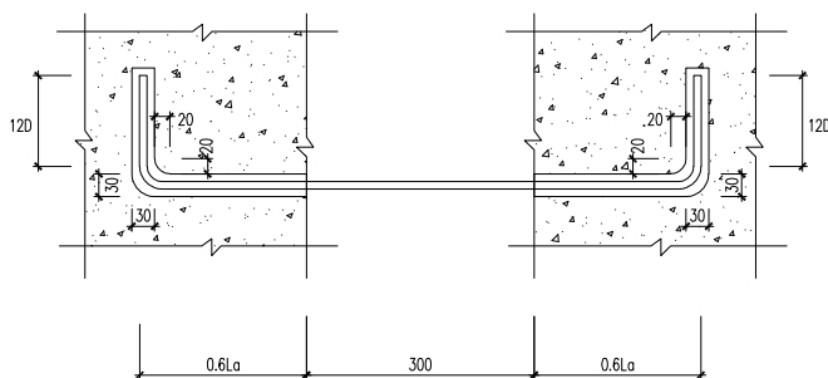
不出筋叠合板后浇区中部]型连接筋平面图
